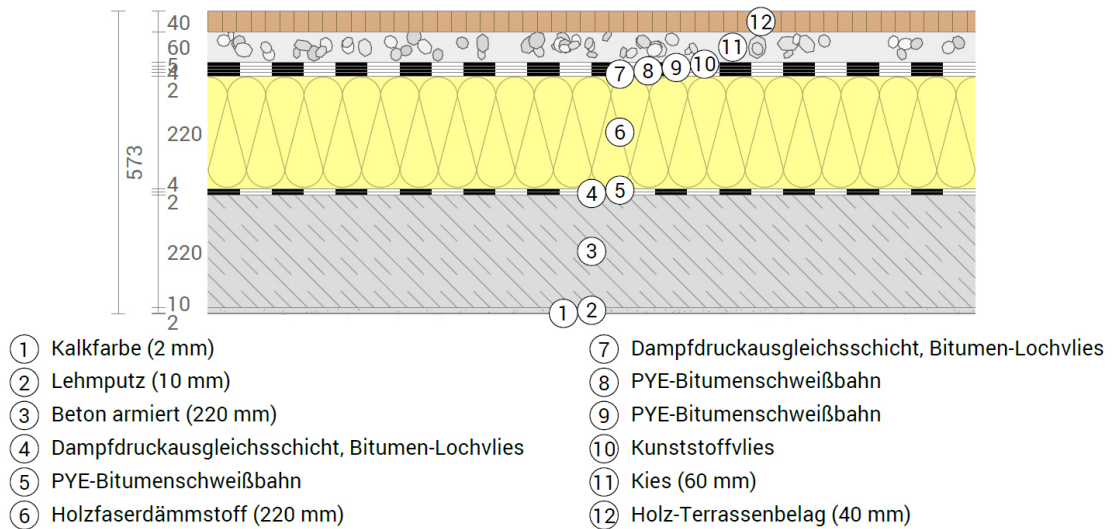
Bauteilaufbau der Dachterrasse (KFK-Variante)
